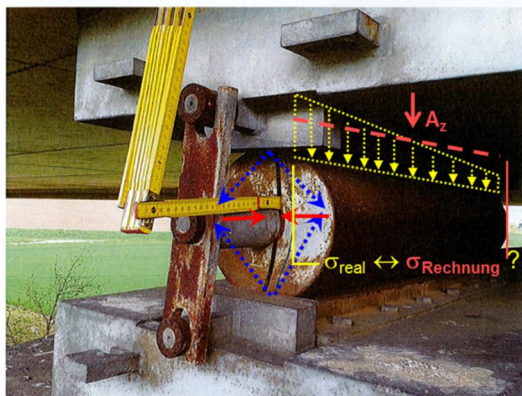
Teilweise aufgespaltetes Edelstahlrollenlager (links) mit temporärer seitlicher Hilfsabfangung (rechts) einer Brücke mit Baujahr 1975
